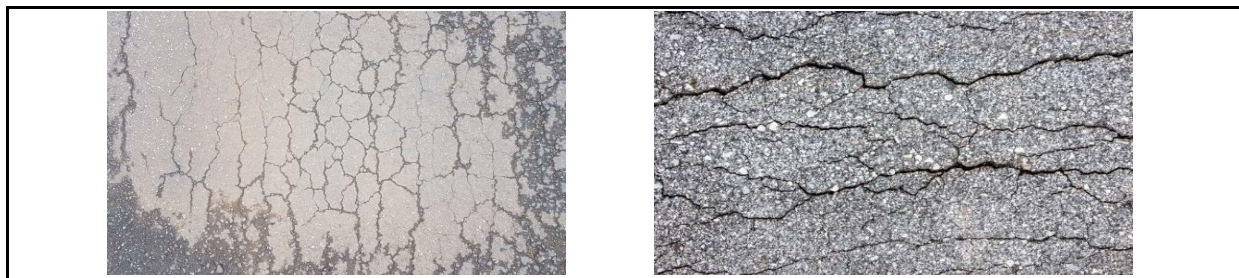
Photo illustrative de la fissuration.
